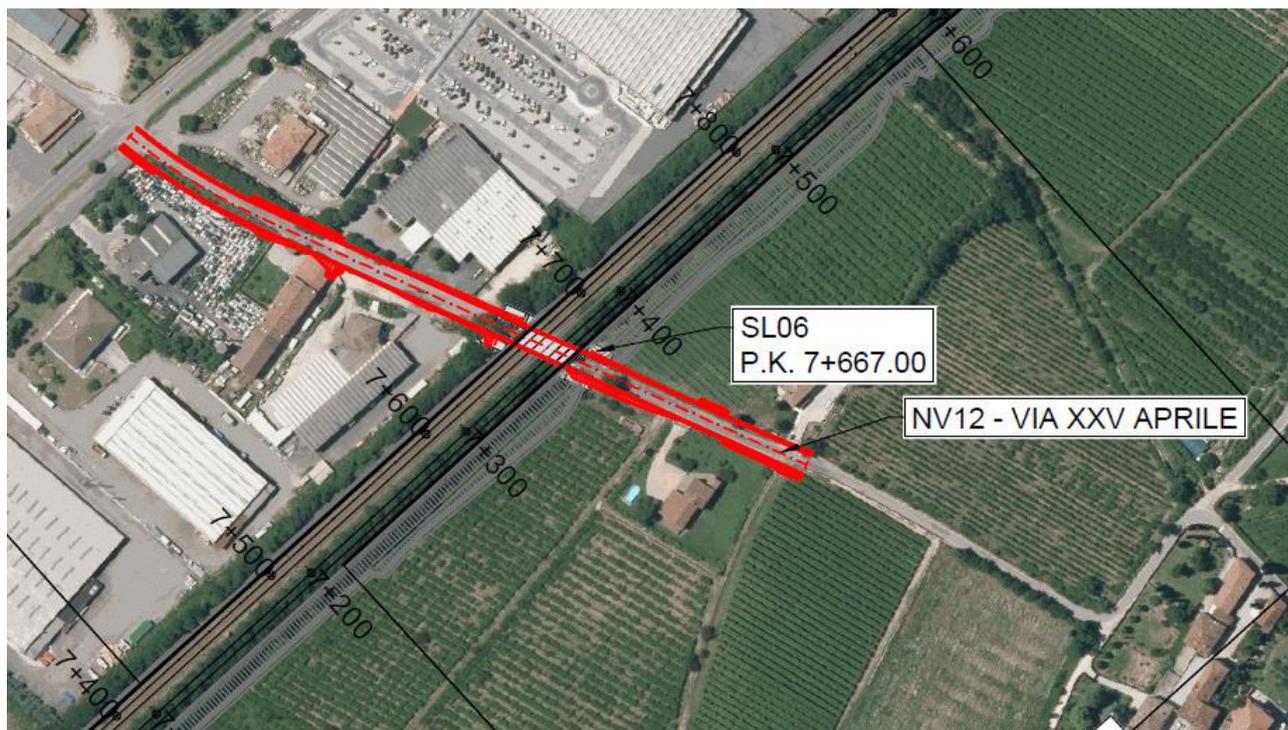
NV12 – Stralcio planimetrico su ortofoto Via XXV Aprile
